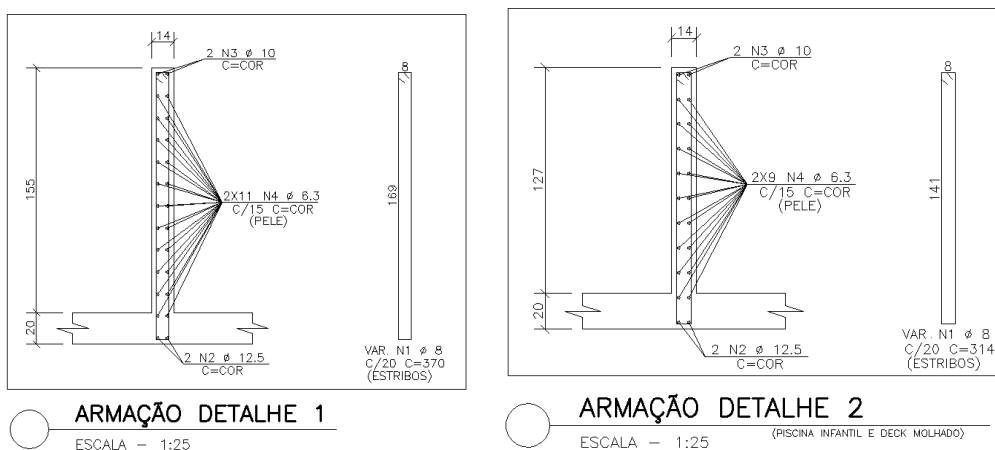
Engastamento entre a laje e a parede prevista no projeto estrutural
